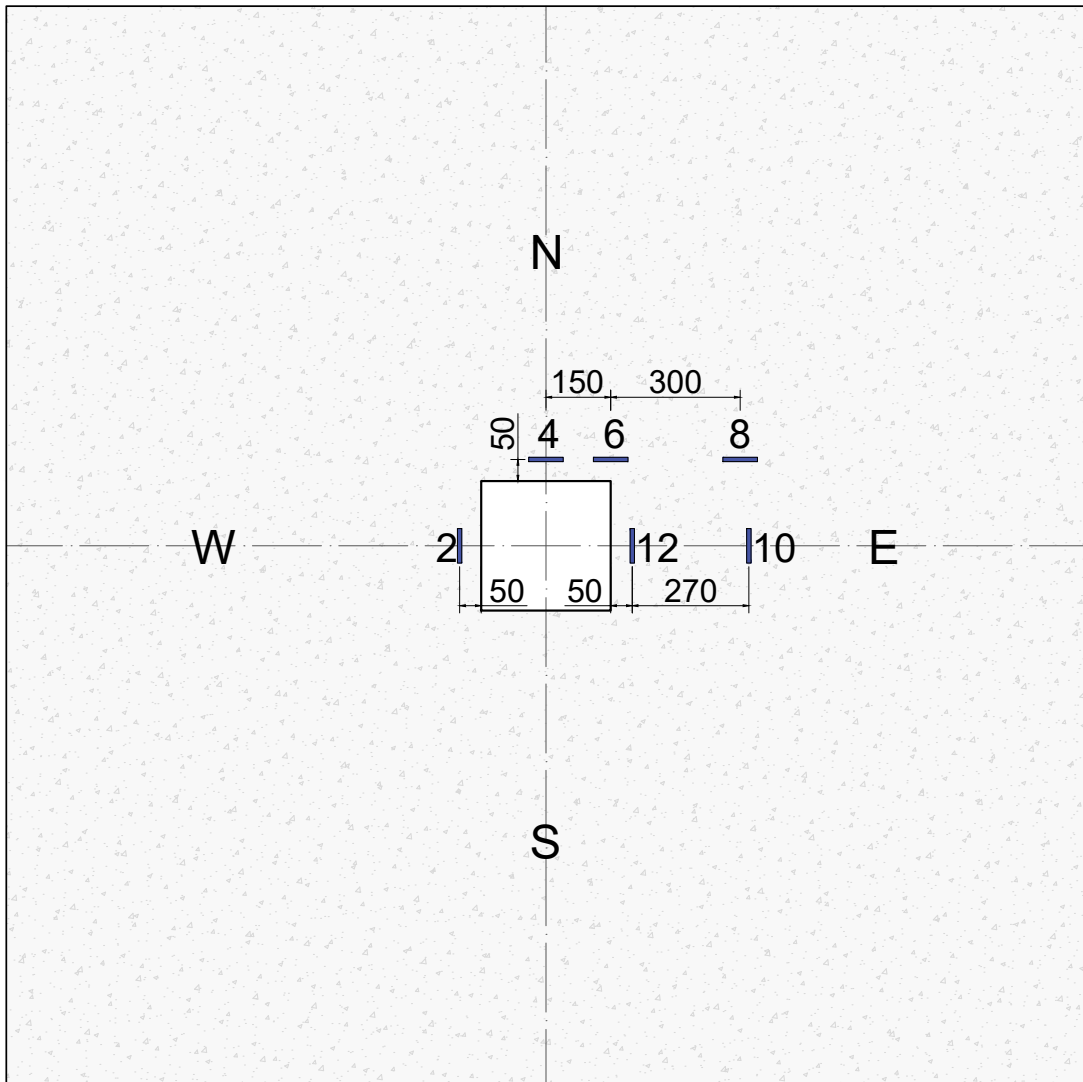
Posicionamento dos extensômetros tangenciais na laje sem aberturas [mm]
